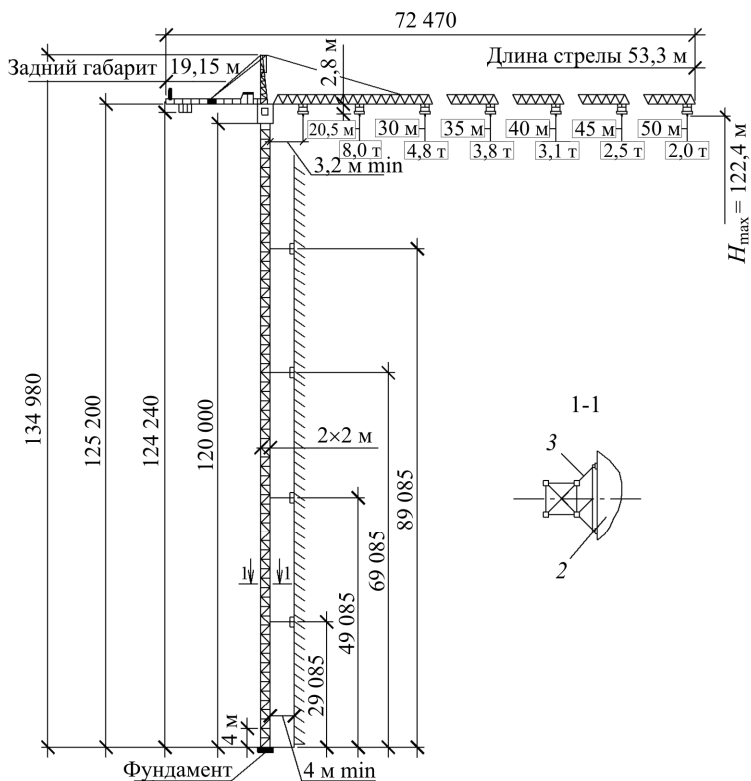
Приставной башенный кран КБ-473 на монолитном фундаменте: 1 – фундамент; 2 – здание; 3 – настенные опоры
